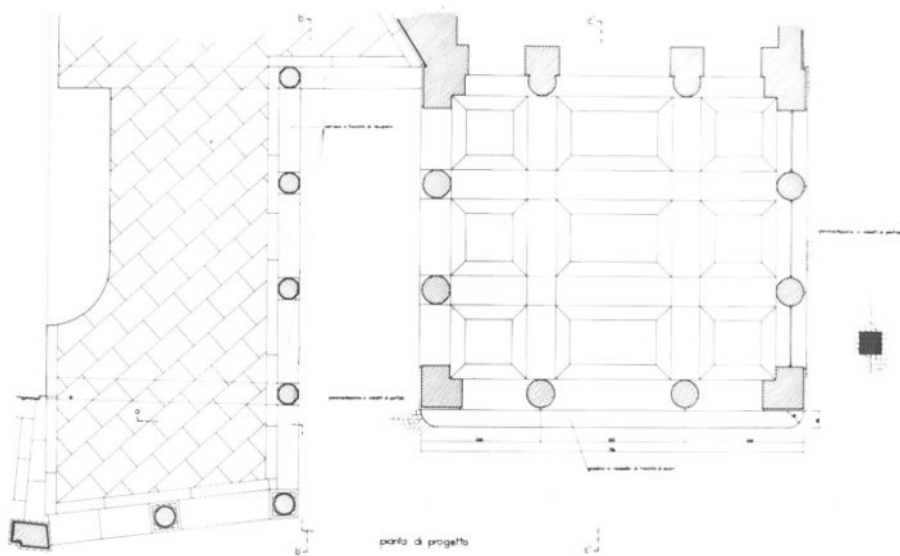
Progetto della pavimentazione, realizzata per isolare la loggetta con un'unica superficie a cubetti di porfido.
